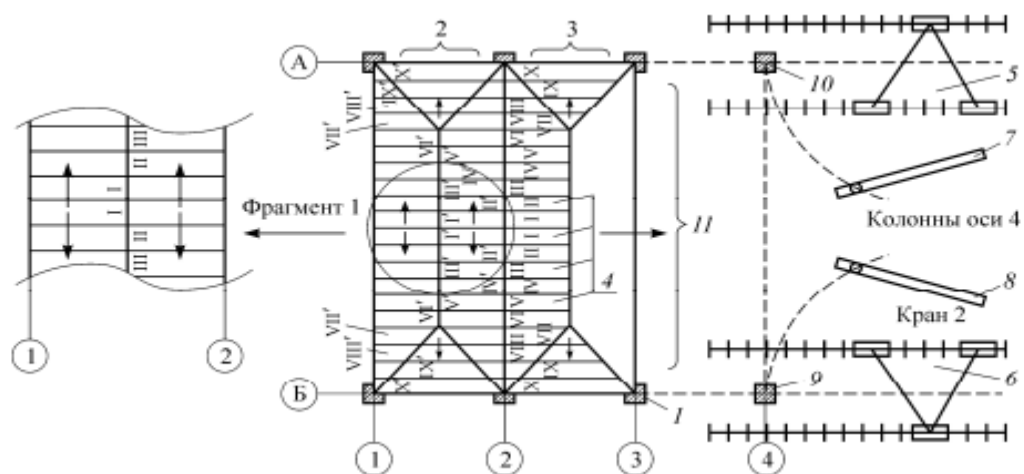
Фрагмент монтажу плит покриття в «типовому» чарунку будівлі та встановлення колон для подальшого монтажу блоку балки в черговому чарунку будівлі: 1 – змонтовані колони; 2, 3 – змонтовані блоки балок; 4 – плити покриття; 5, 6 – крани СКР-1500; 7, 8 – колони перед встановленням їх на проектні осі; 9, 10 - встановлені колони для монтажу блоку в осях 3-4; 11 – місце чергового монтажу блоку; I... VIII – технологічна послідовність встановлення елементів покриття
